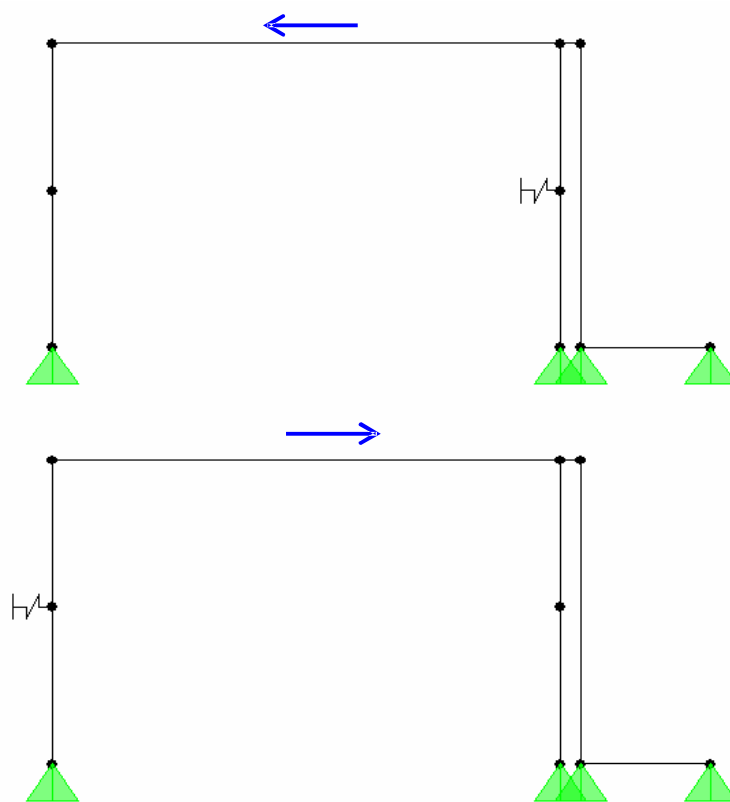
Modelo estructural adoptado para verificar el refuerzo de los muros de adobe.
